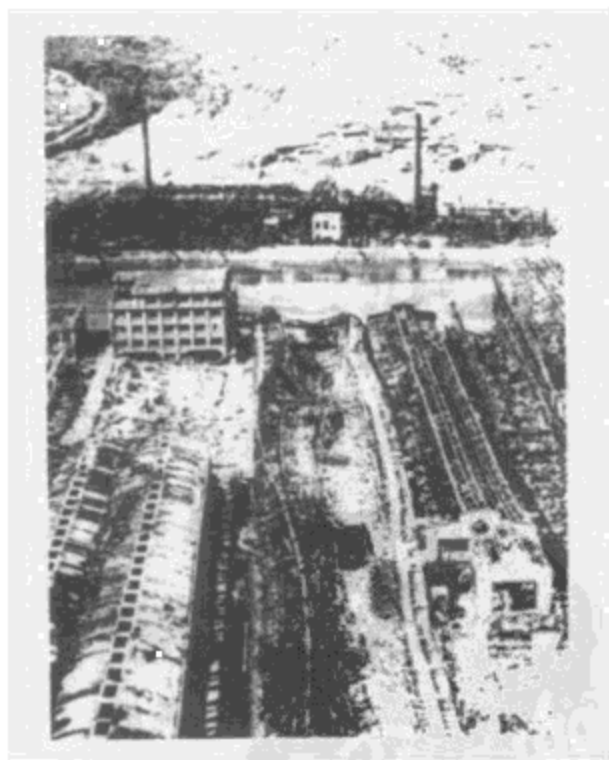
钢筋混凝土建筑房顶及地板塌陷的情况
